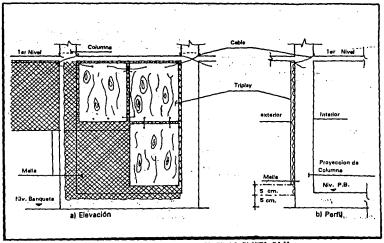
PROTECCION EXTERIOR EN LA PLANTA BAJA
